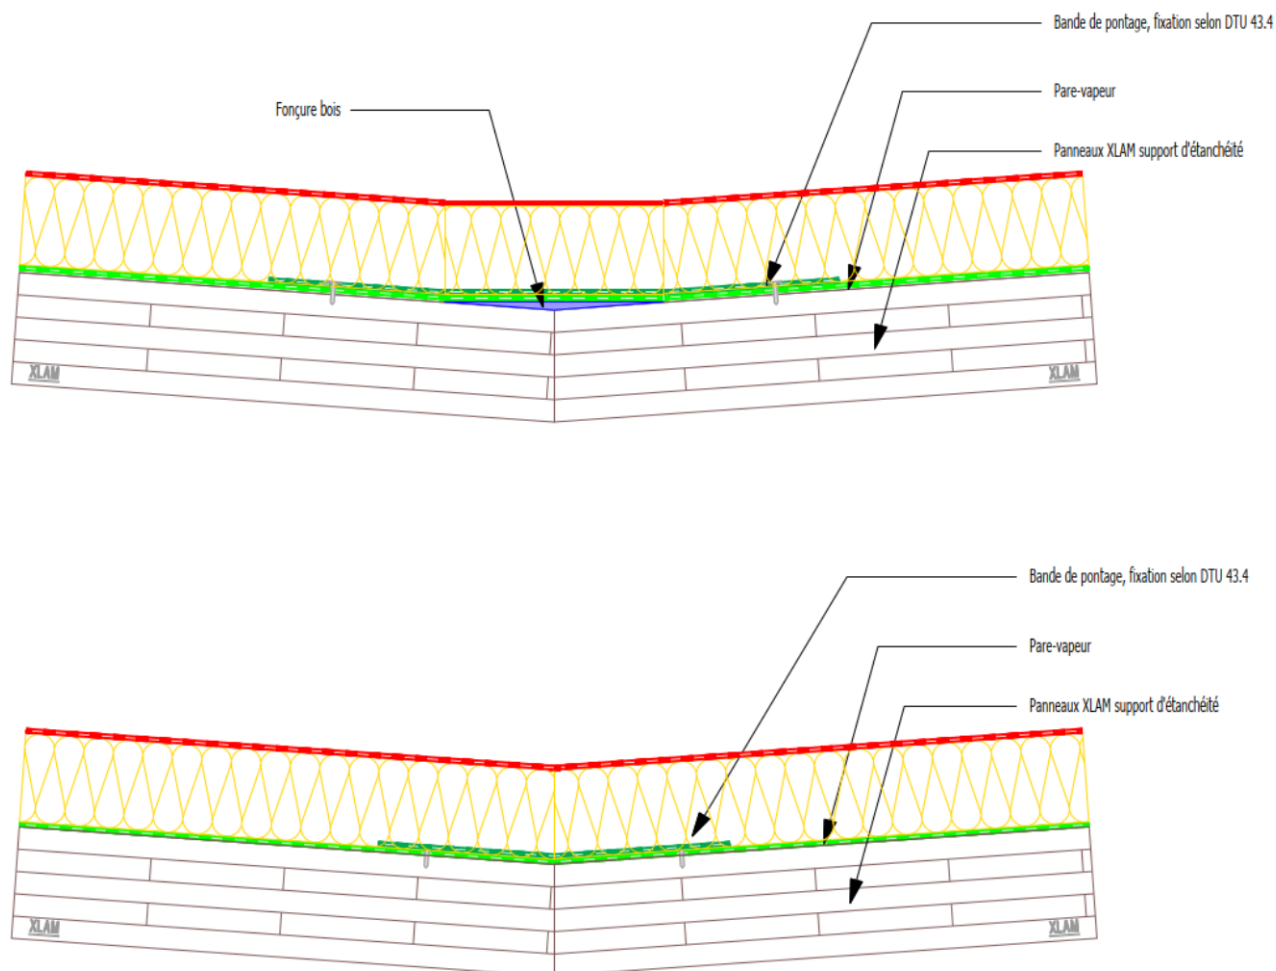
Exemple de traitement d'un joint de dilatation en toiture chaude accessible aux piétons et au séjour
